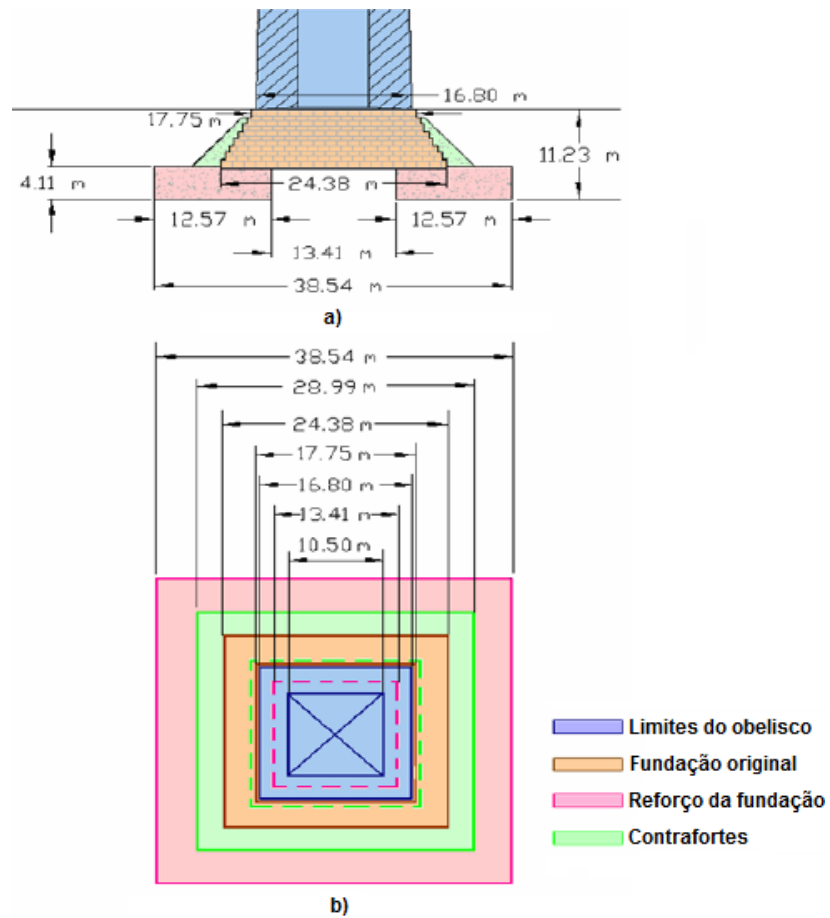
Esquema da fundação existente e do reforço realizado: a) corte; b) planta [10]
